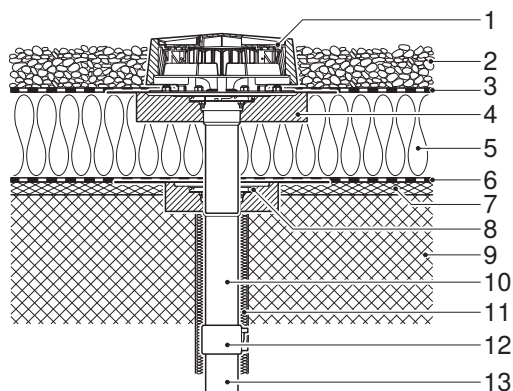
Montage dans toiture massive isolée avec revêtement d'étanchéité et pare-vapeur
